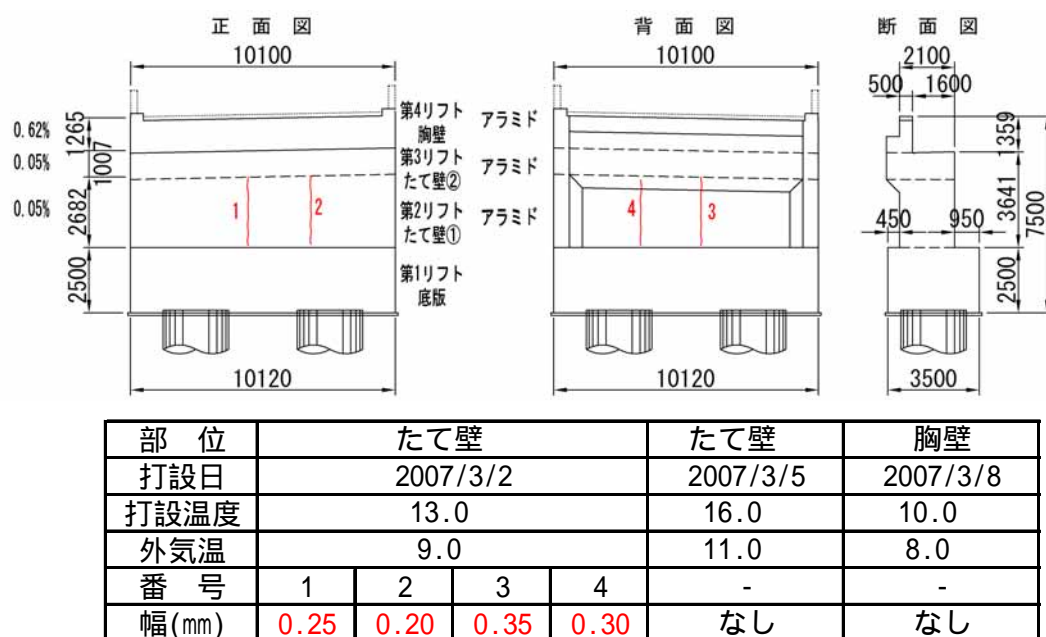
アラミド繊維ひび割れ発生状況
